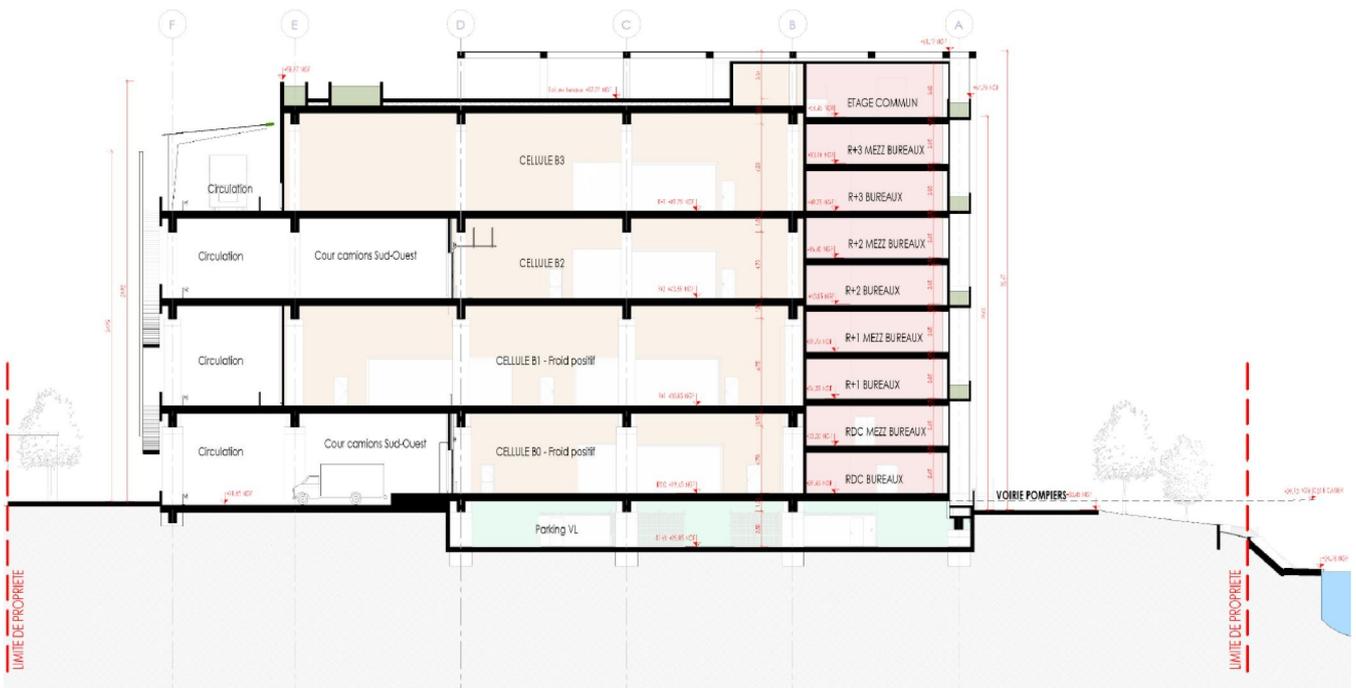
coupe du projet au droit des bureaux (source : note de cadrage, p. 27).
